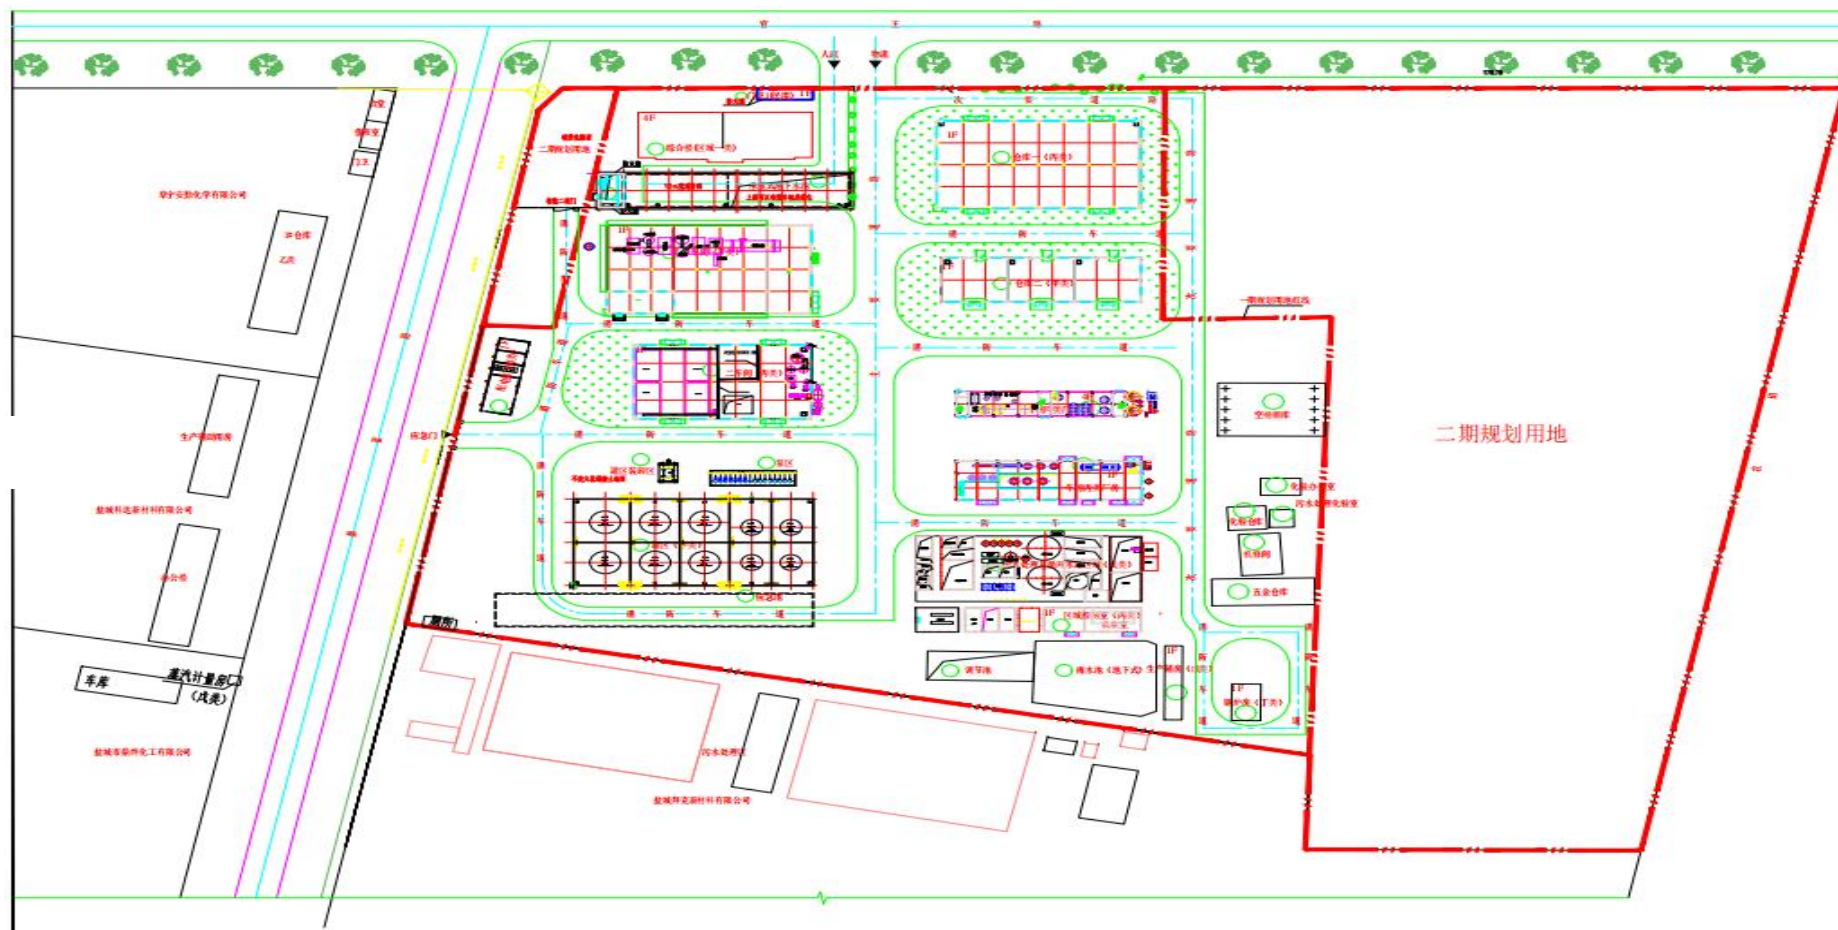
江苏绿瑞特环境科技有限公司平面布置图
